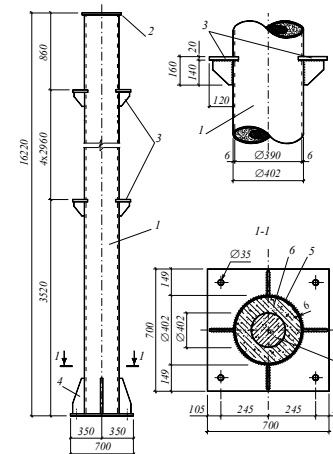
Трубобетонная колонна жилого дома, возводимого методом подъема этажей:
